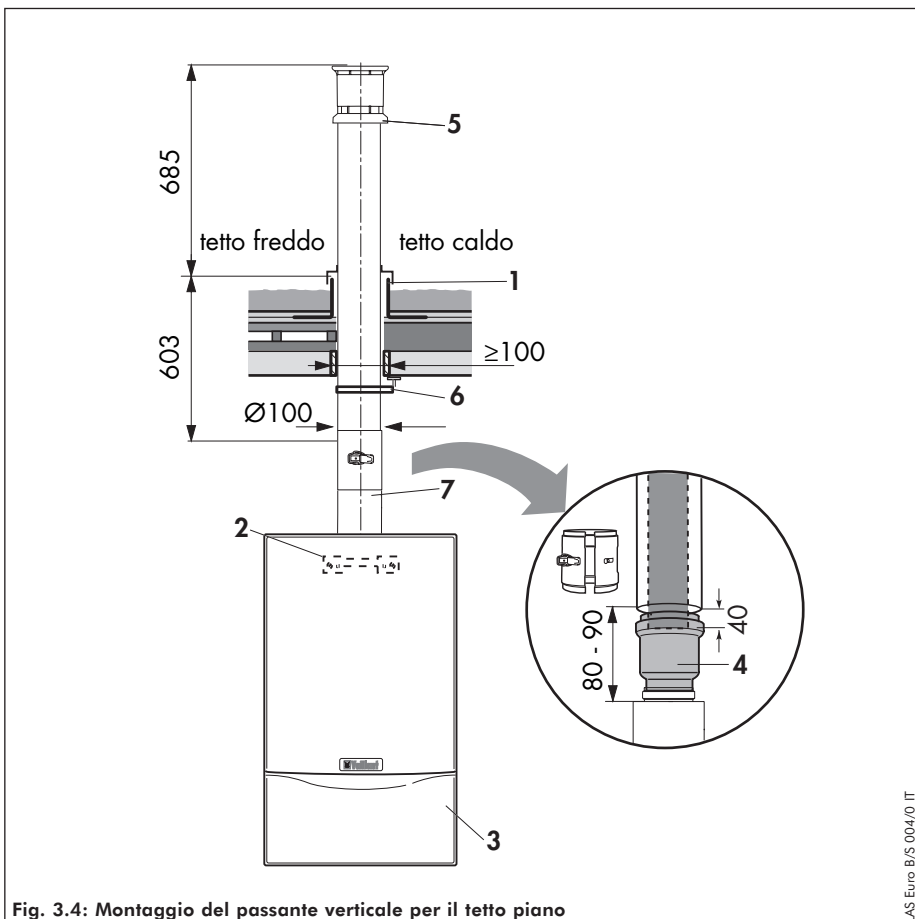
Montaggio del passante verticale per il tetto piano
